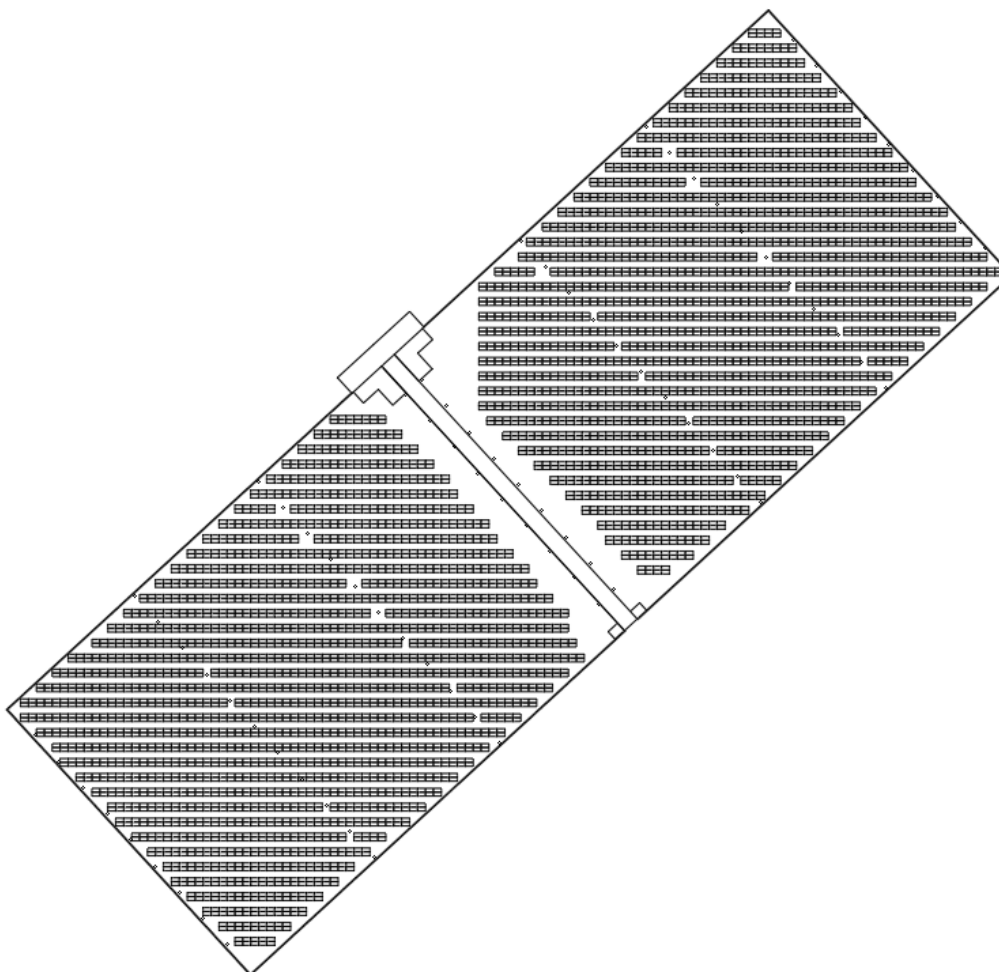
Plano de la cubierta del depósito con implantación fotovoltaica
